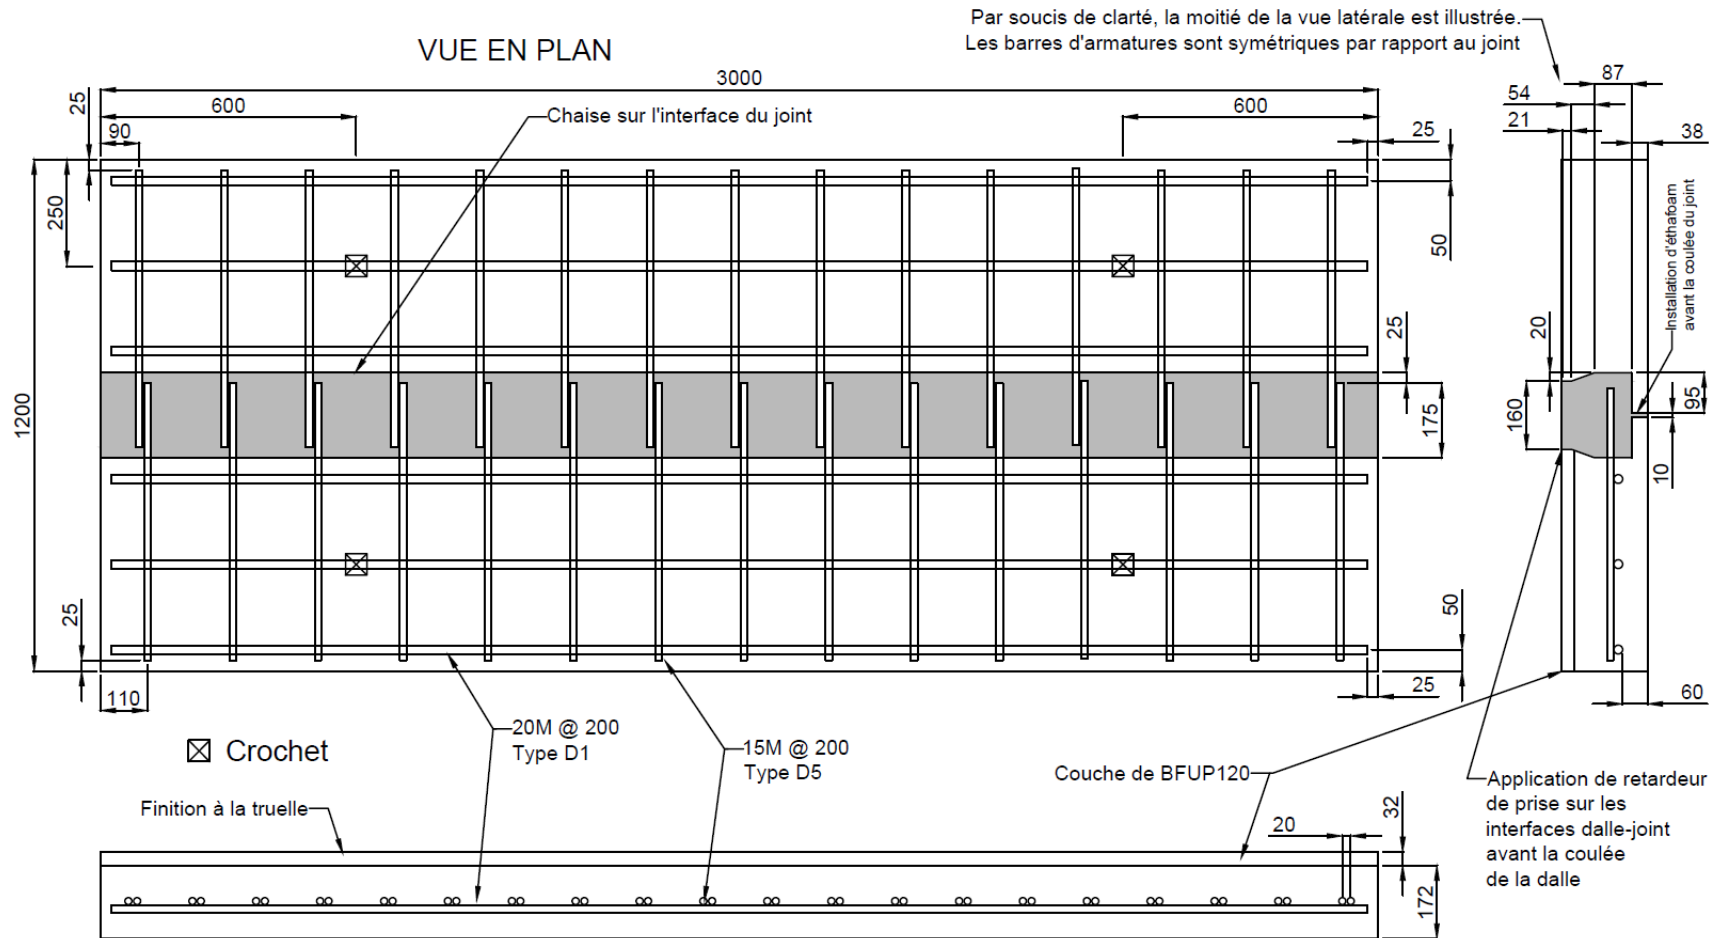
Dalle hybride avec joint de connexion transversale (TQC) pour le test statique (#4.1)
